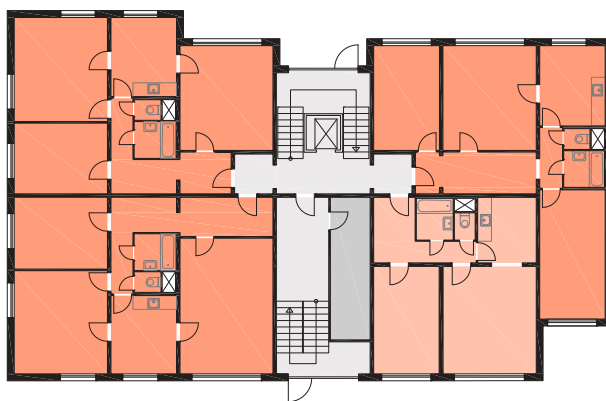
Konstrukční soustava OP 1.31 - Havířov (Zdroj: panelaky.info)
